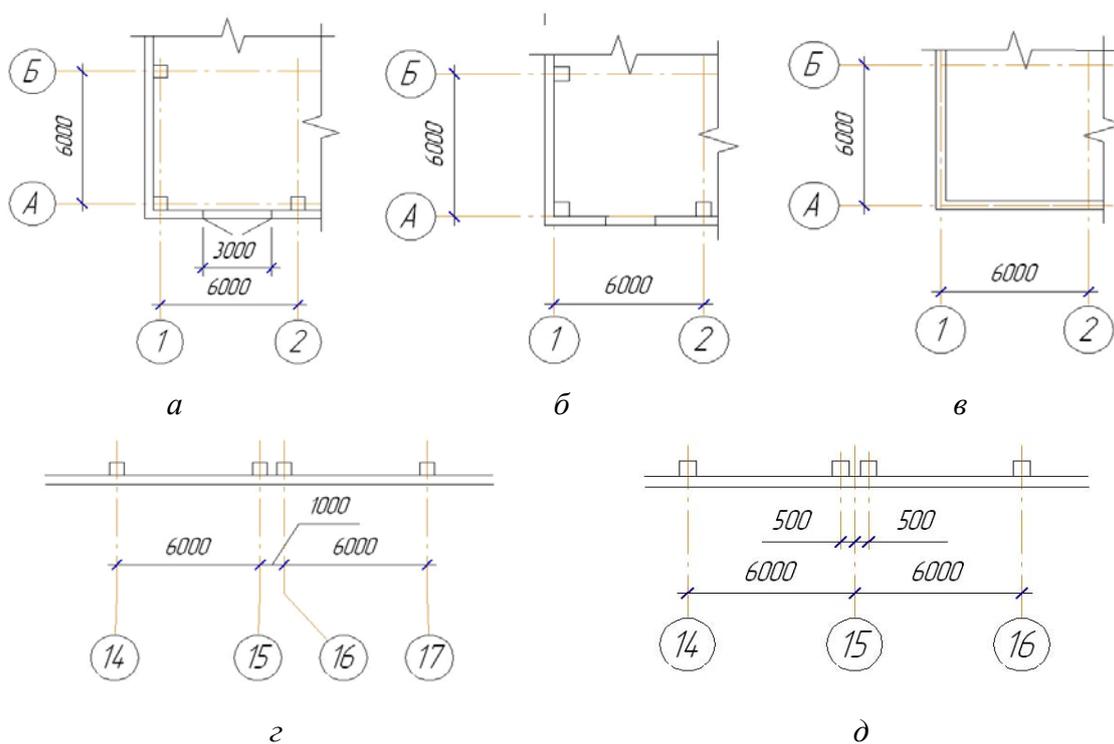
Пример привязки стен и колонн здания к разбивочным осям:
